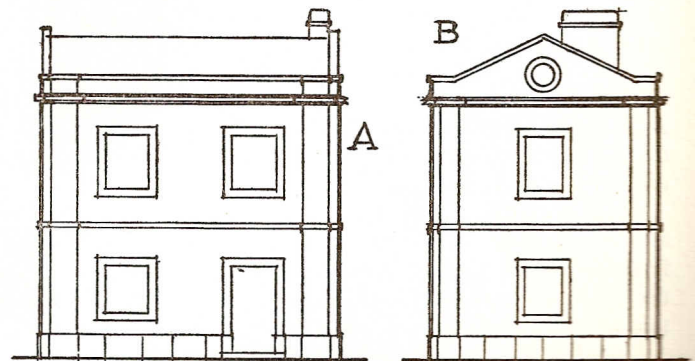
FACHADA E EMPENA DE UMA EDIFICAÇÃO
